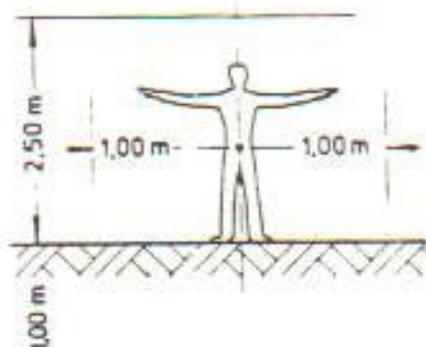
Aislamiento de las partes de la instalación bajo tensión.
